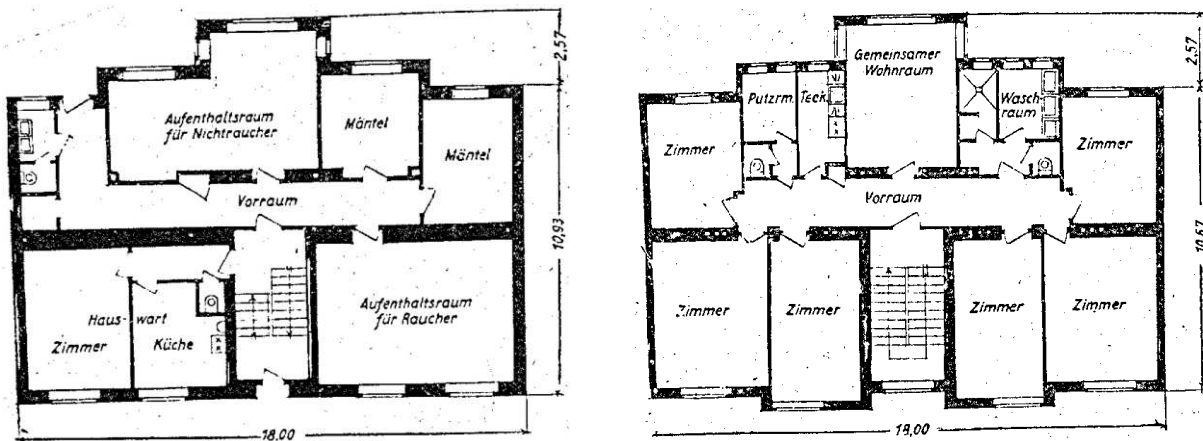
Ledigenheim, Wien, Geschossgrundrisse, um 1928.
